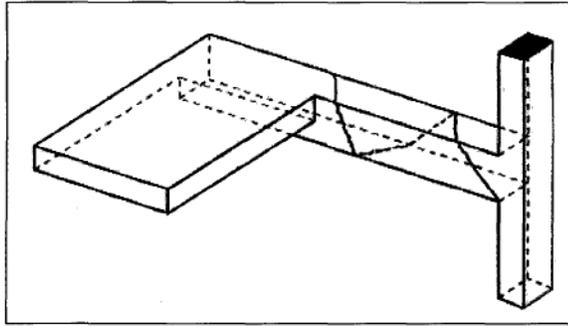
Fisuración por torsión en viga: de tipo helicoidal, con anchos de hasta 0.1mm
